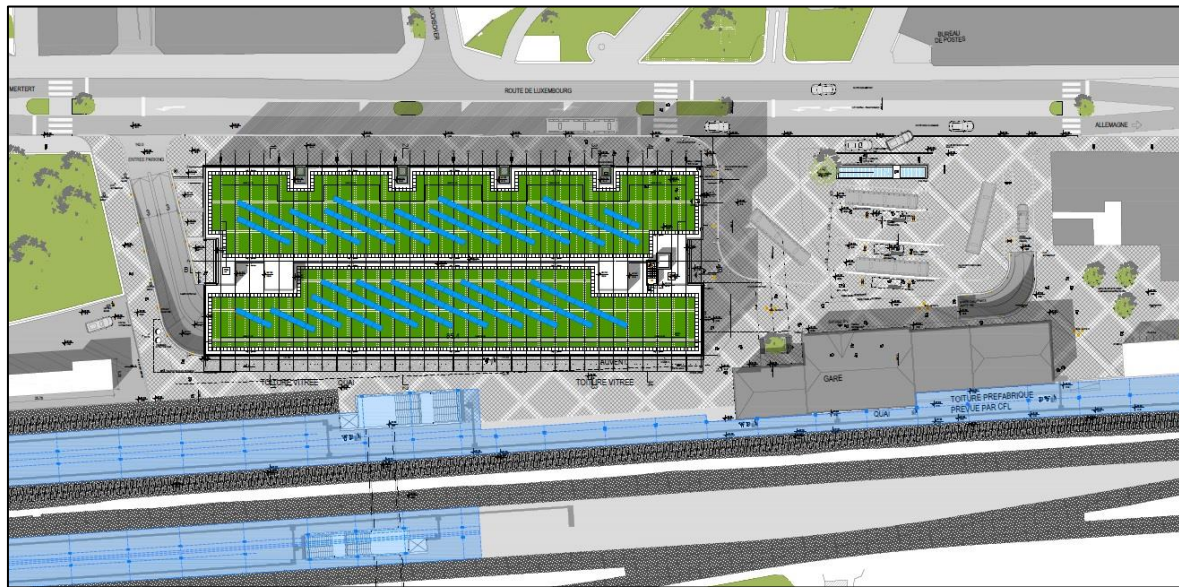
Geplante Neugestaltung des Bahnhofsgeländes Wasserbillig („Plans – Plan Masse“ © Architectes Paczowski et Fritsch, Planentwurf vom 08. September 2017).
